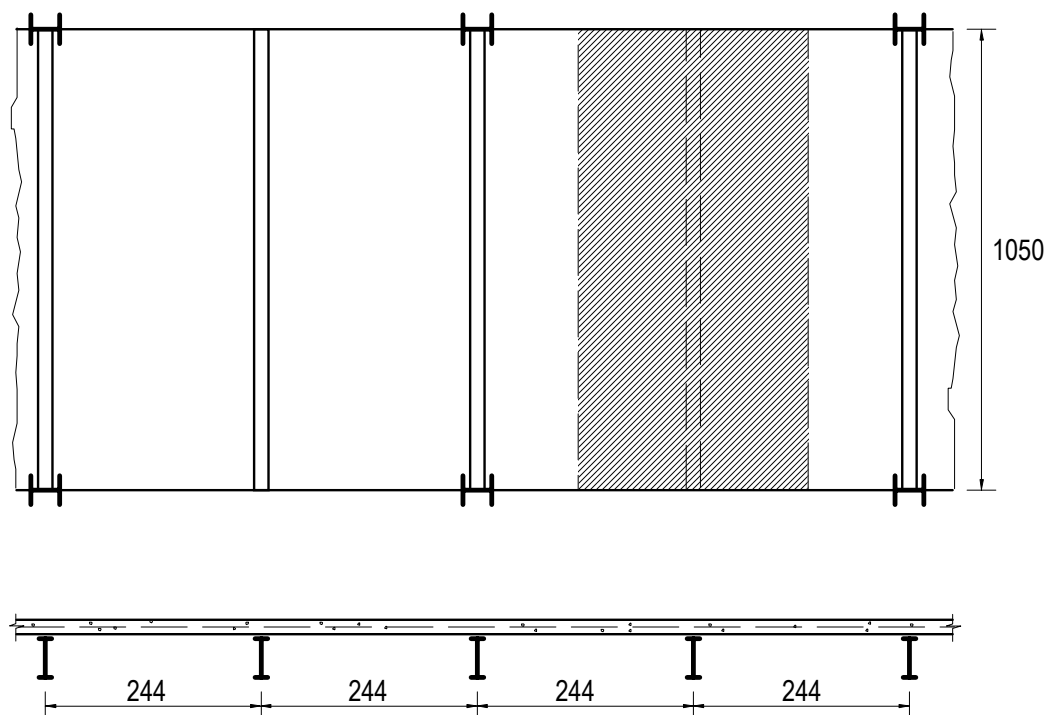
Esquema do pavimento para o exemplo D2
